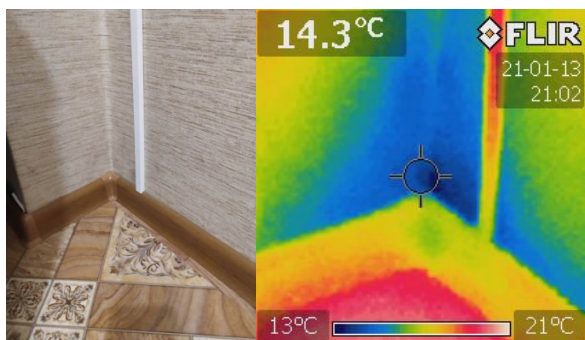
Термограмма стыка наружной стены и межэтажного перекрытия панельного дома
